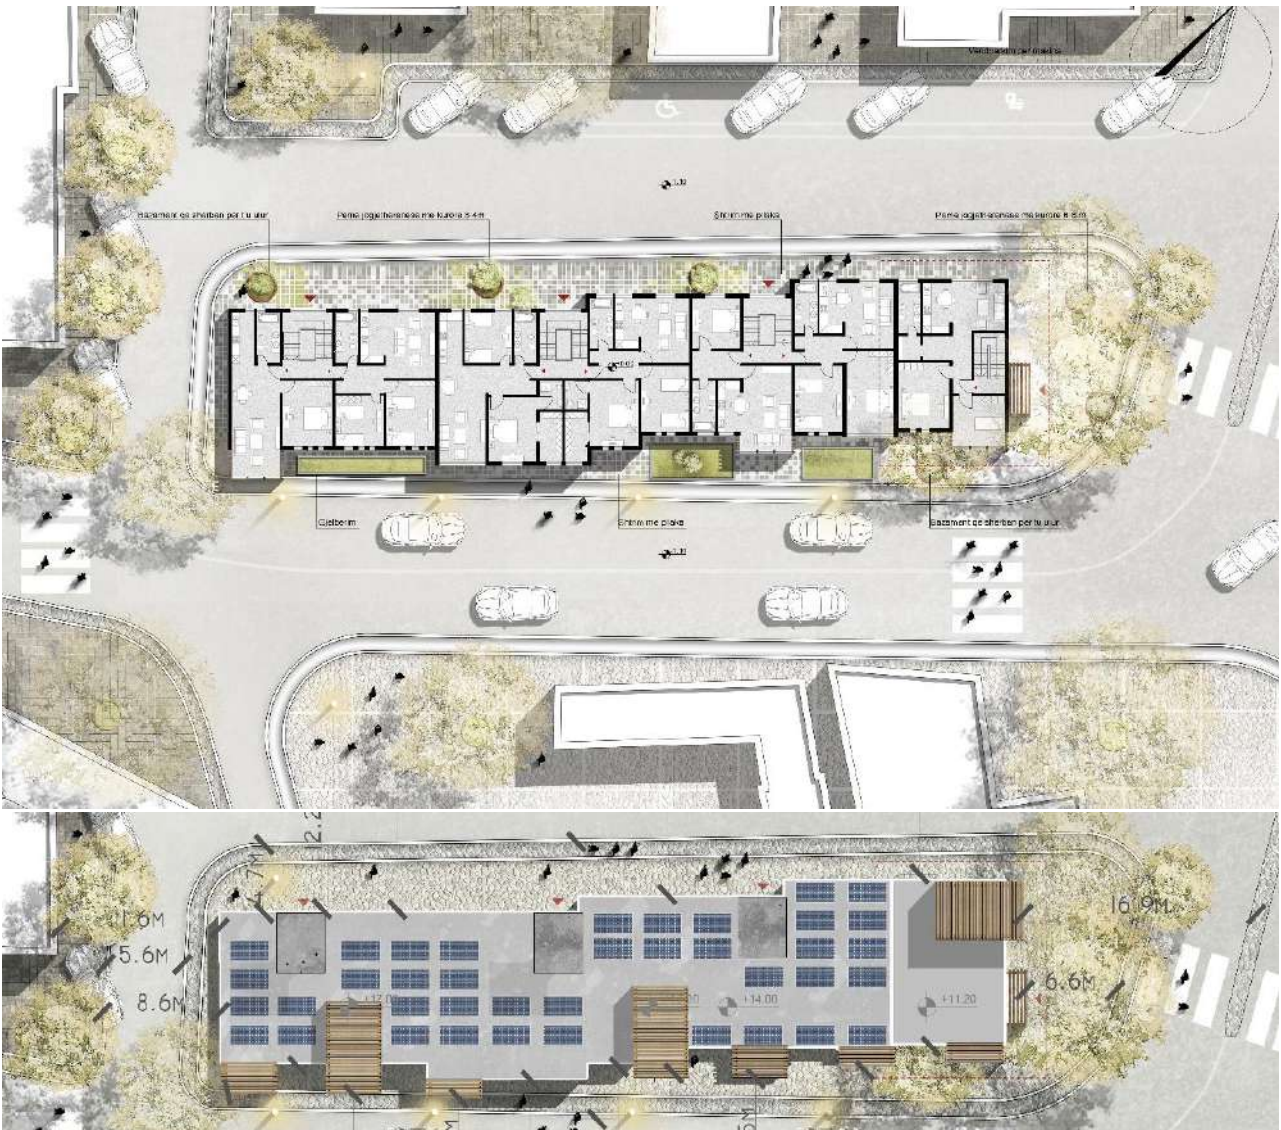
Planimetria generale e planivolumetrico dell'edificio di progetto
